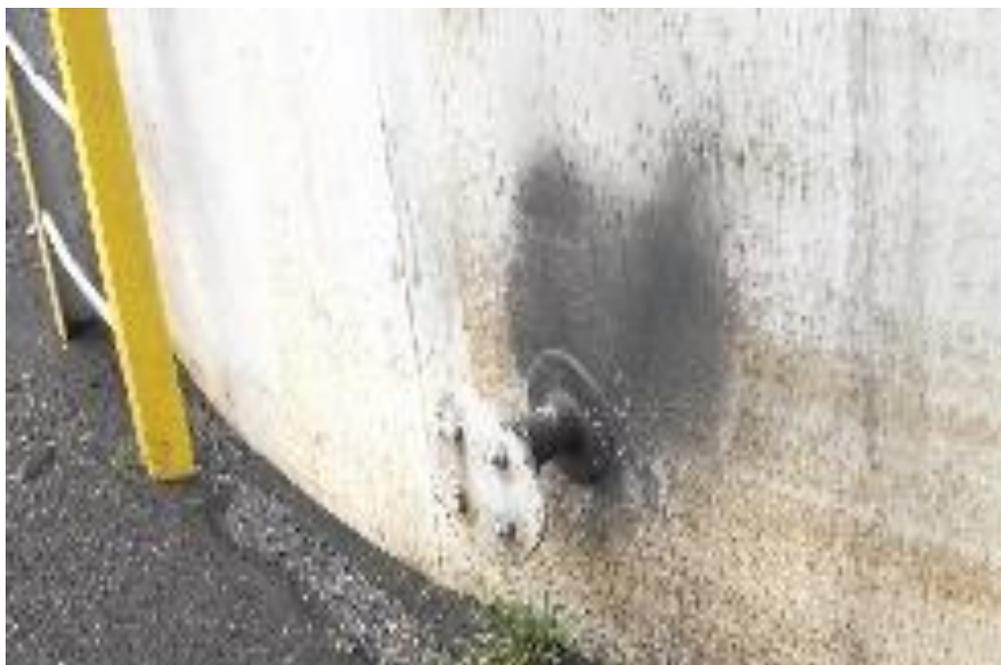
Глухой фланец противопожарного резервуара №2
